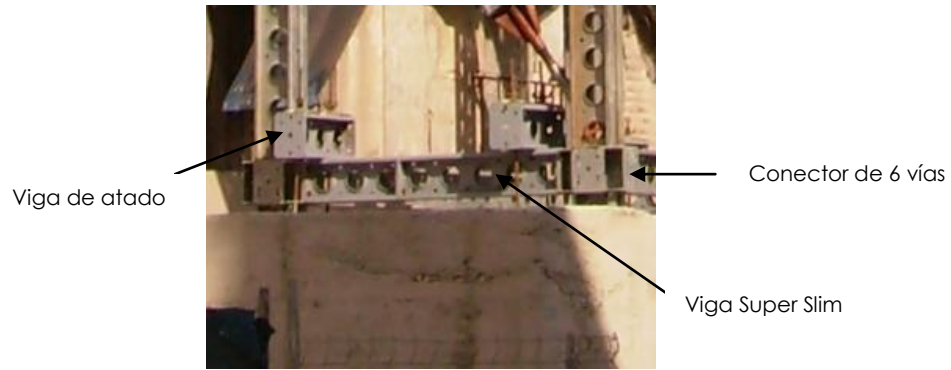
Unión entre la torre del estabilizador y el contrapeso. (Fuente: Lucas Blancas)
